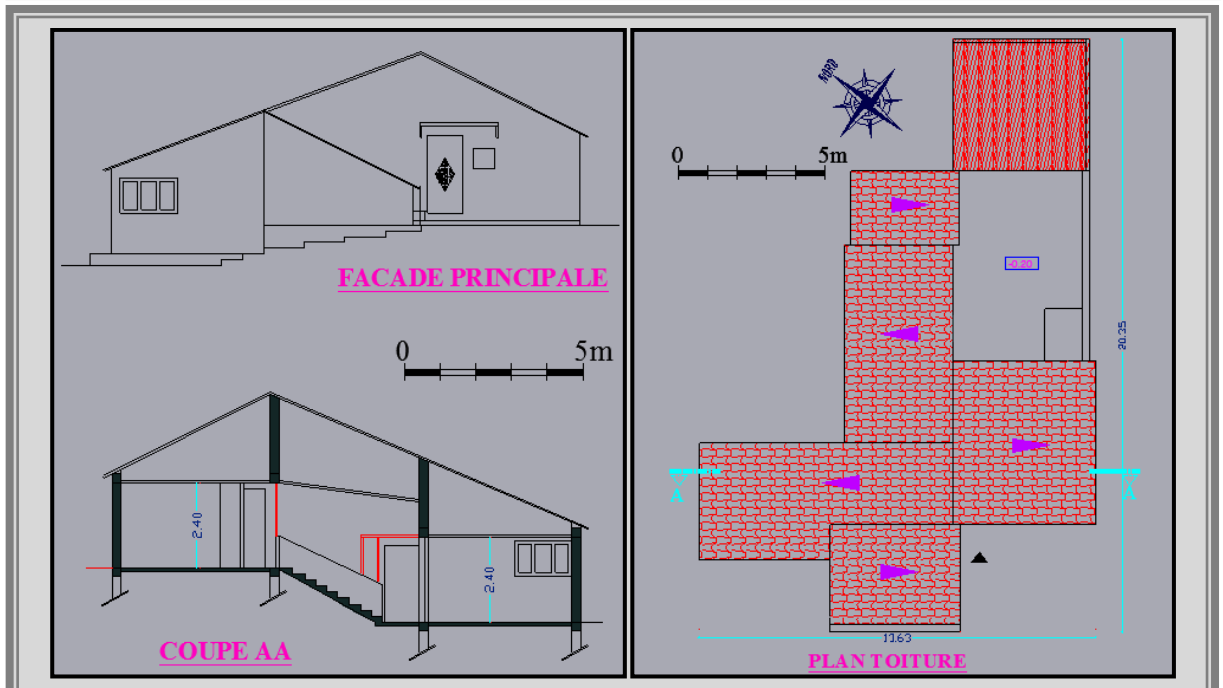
Façade, coupe et plan terrasse de la maison étudiée.
